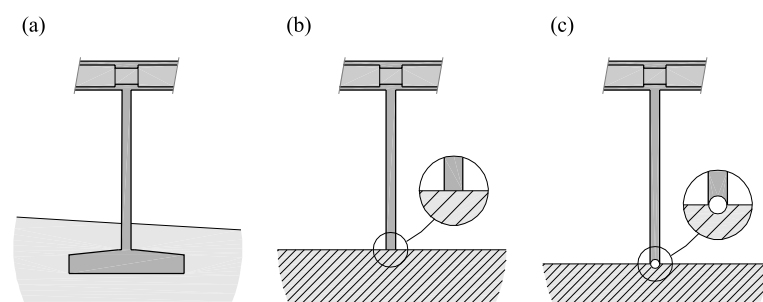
Liaison entre le pied de la pile et le sol de fondation ; (a) fondation superficielle ; (b) encastrement du pied de pile dans un sol de fondation d'extrêmement bonne qualité ; (c) rotule entre la fondation et le pied de pile
